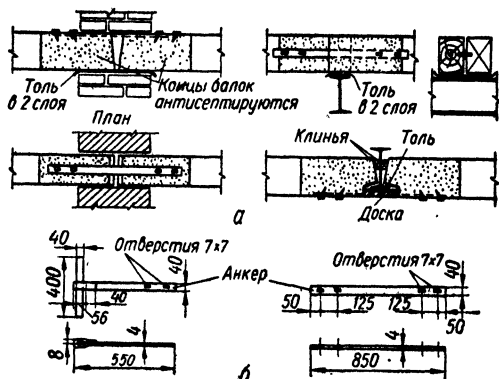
Опираие балок на внутренние конструкции (а) и анкеровка (б).
